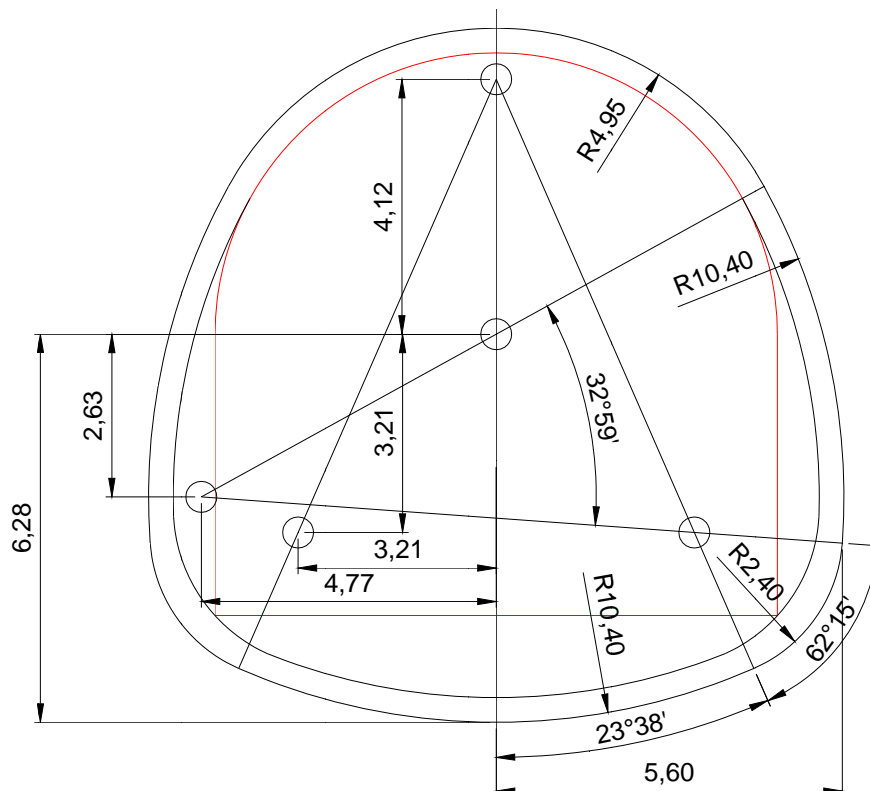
Seção estrutural e hidráulica (vermelho) do túnel na Alternativa 3.
